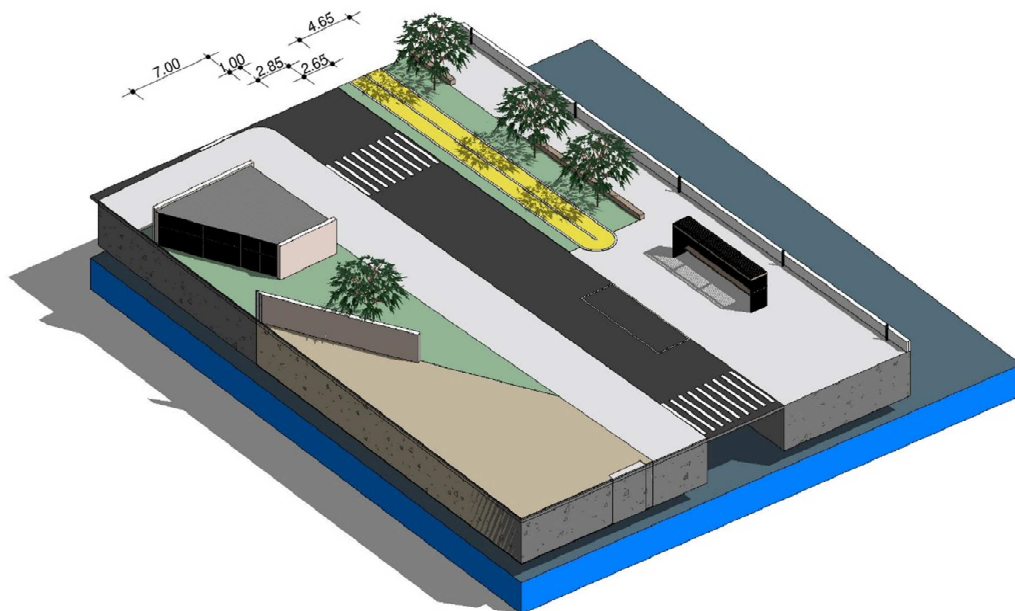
ESQUEMA PERFIL DE RUA PROPOSTO– IMAGEM: AUTOR
